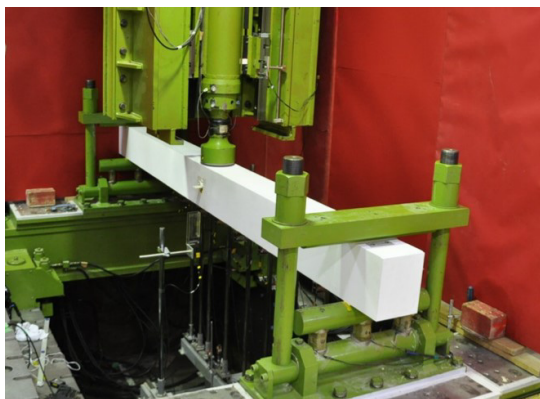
衝撃荷重荷重時の実験装置と試験体の設置状況
